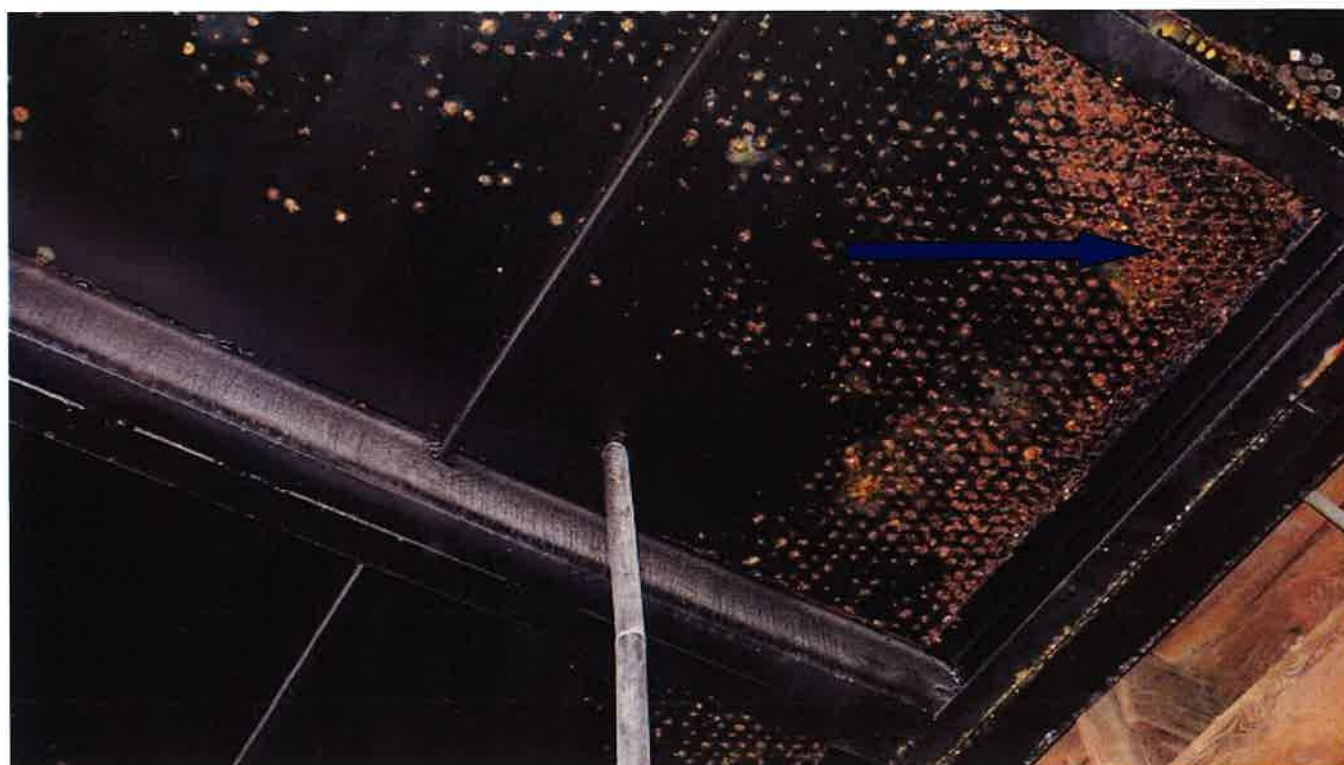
, 38. Konstrukcja pomostu wieży widoczna od spodu. Zacieki, korozja stali.
